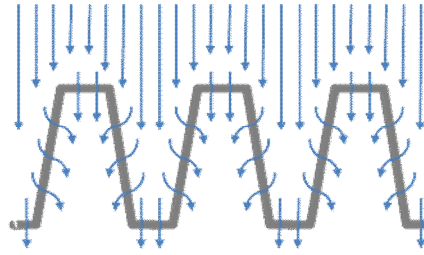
Vista en planta de un vertedero de laberinto tipo Trapezoidal.
